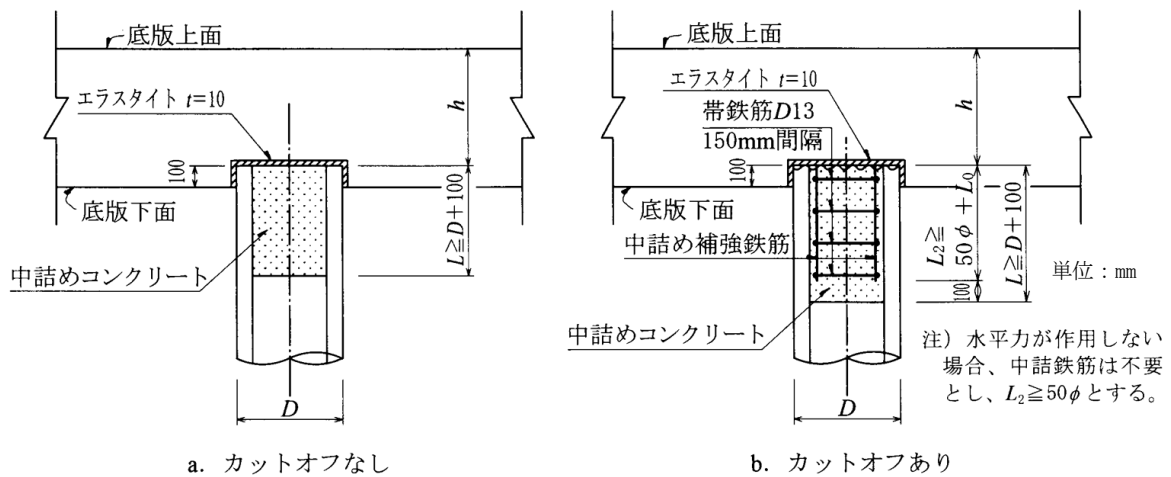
PHC 杭の杭頭処理（ピン結合）
